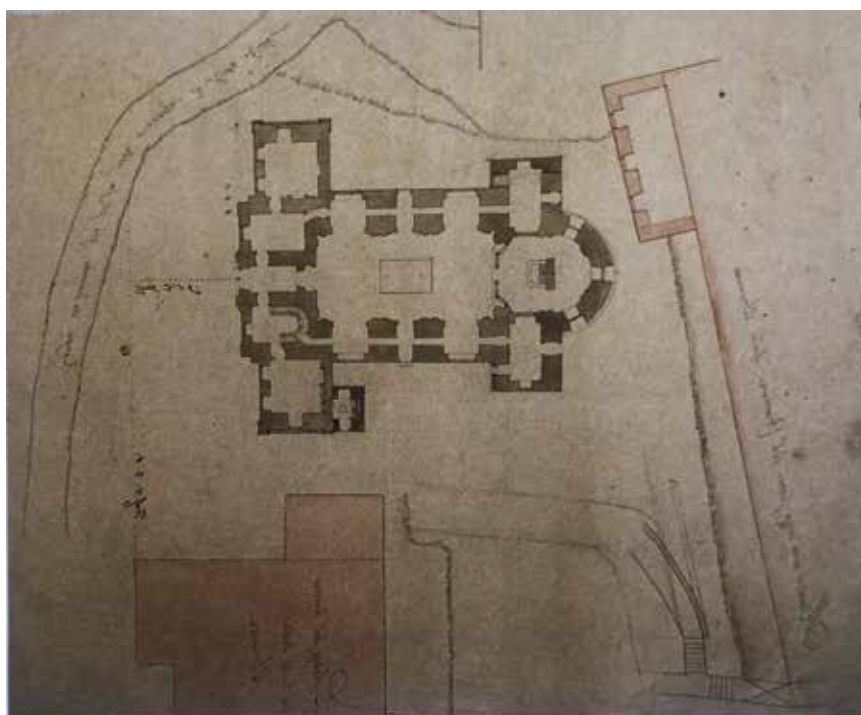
Pianta della chiesa con suo ingombro e localizzazione. Di fianco ad essa il Palazzo del Governo mentre alle sue spalle la Batteria Reale, Barri P., ISCAG, Brunetta, Cartella LIX B, n.3743
